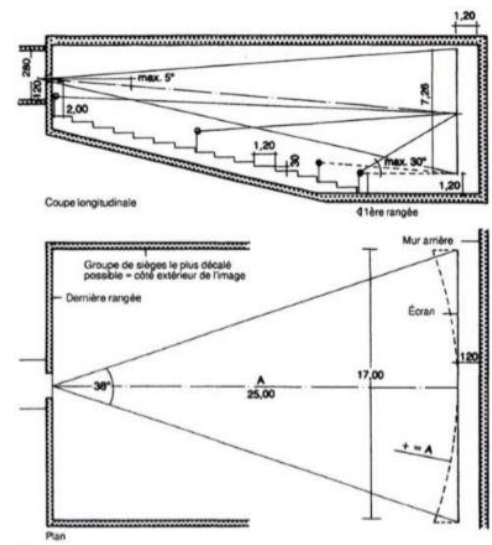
Plan et coupe d'une salle de projection (Neufert)
